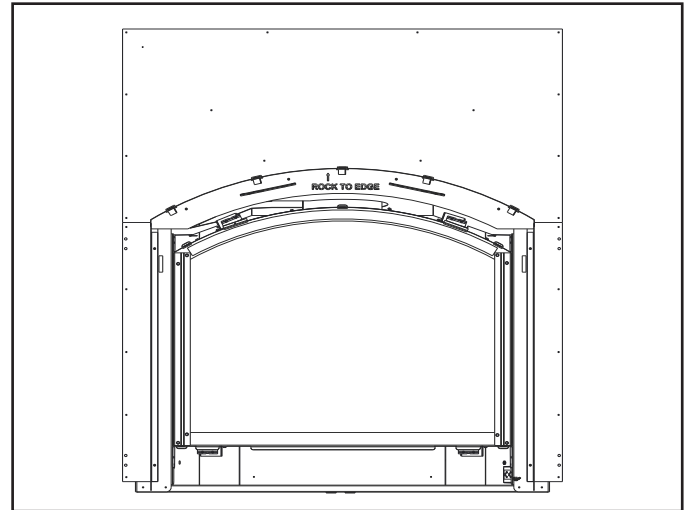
Pièces de finition du haut et de la voûte assemblées
